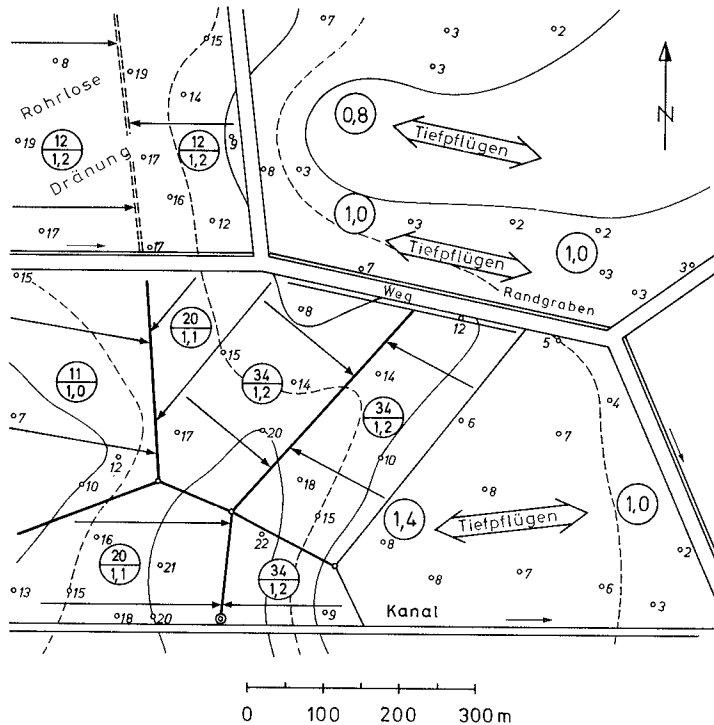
Lageplan für Rohrlose-Dränung und Tiefpflügen im Moor
